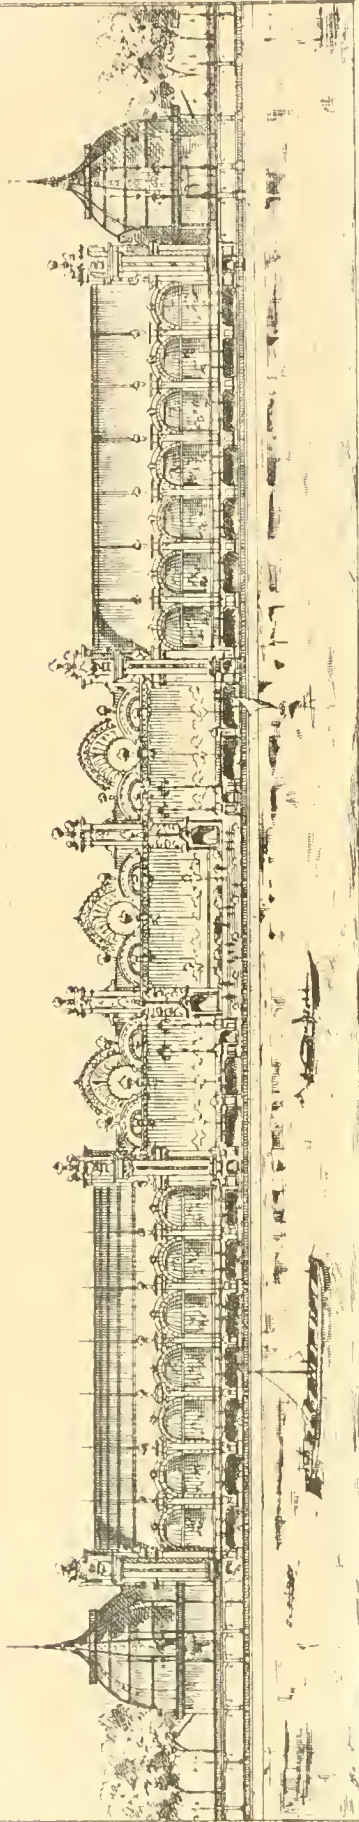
Vue d'ensemble prise du Quai d'Orsay.
